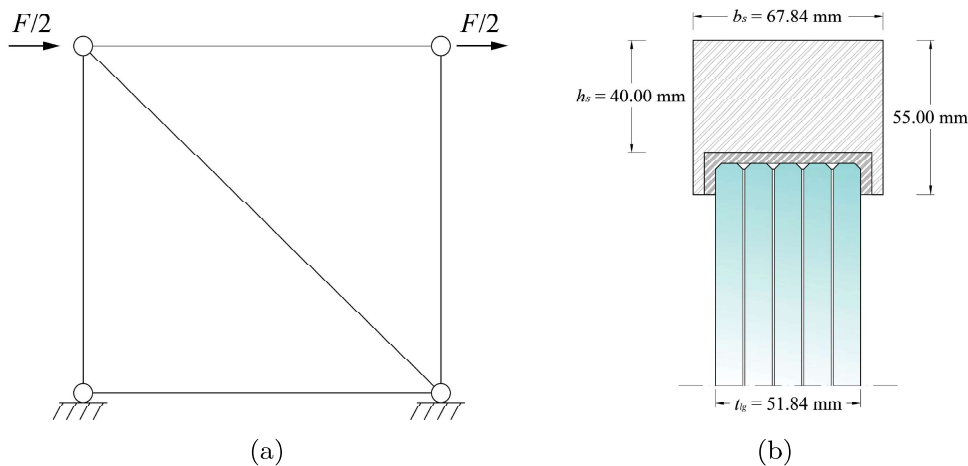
Progetto della sezione trasversale del telaio in acciaio (a) schema strutturale per la valutazione in via approssimata delle sollecitazioni di progetto; (b) geometria della sezione trasversale, nelle FEA 2D è stata assunta la sezione rettangolare di dimensioni $b_s \times h_s$.
